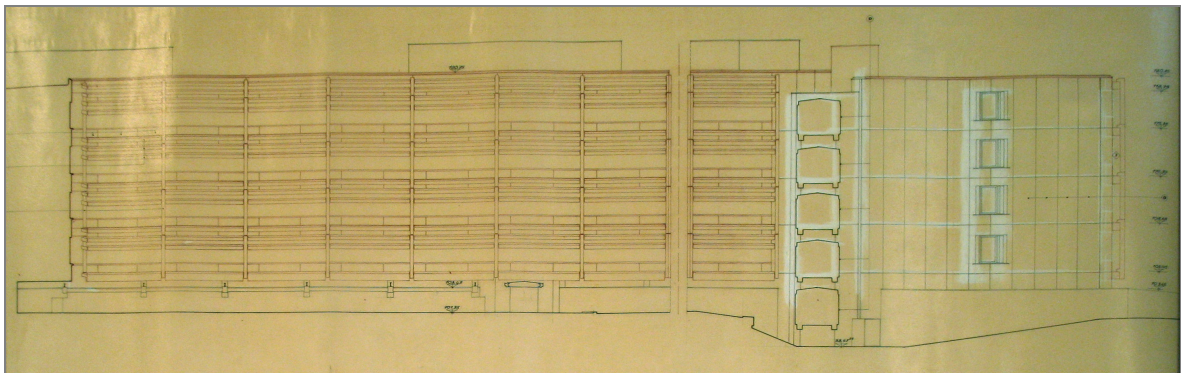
prospetto interno C (fonte CSAC – stralcio tav. 59, archivio n. 384-6)
